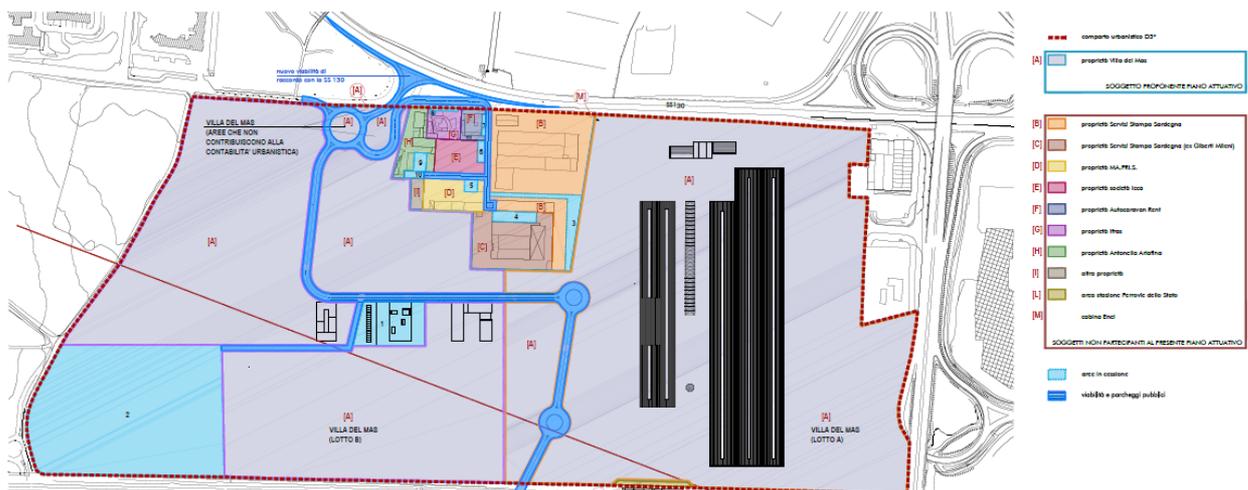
Stralcio dell'allegato P1.1 al Piano attuativo (Planimetria generale – stato di progetto)
